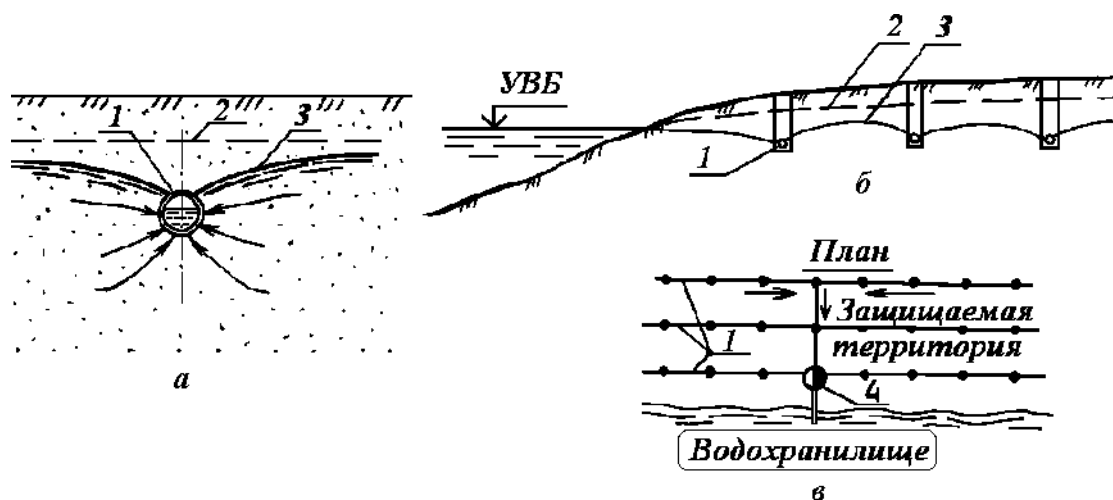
Схема устройства дренажа для понижения уровня грунтовых вод: а — схема работы дренажа; б — расположение дренажа в разрезе; в — план участка берег; водохранилища; 1 — дренажная трубка; 2 — поверхность грунтовых вод до строительства дренажа; 3 — поверхность грунтовых вод после строительства дренажа; 4 — насосная станция для откачки дренажных вод
